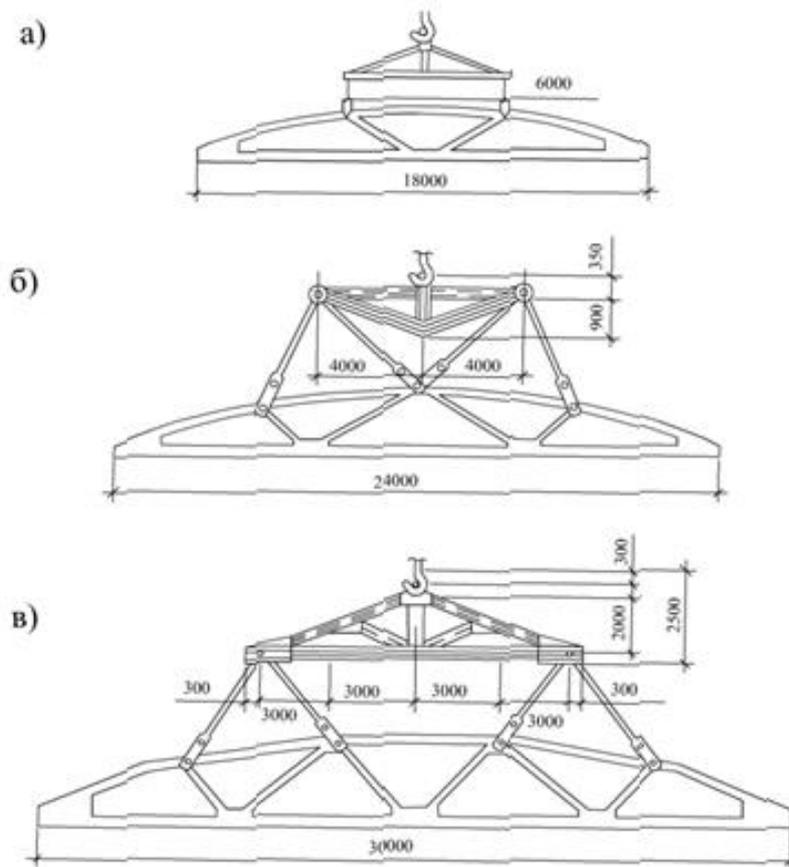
Схемы строповки железобетонных ферм решётчатыми траверсами:
